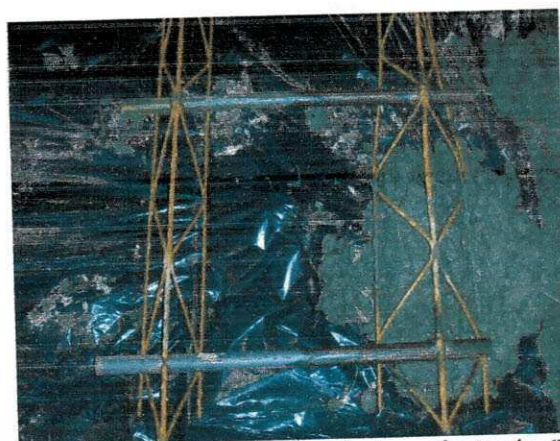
Aplicação de espaçadores e barras de transferência (Fonte: Arquivo pessoal)
